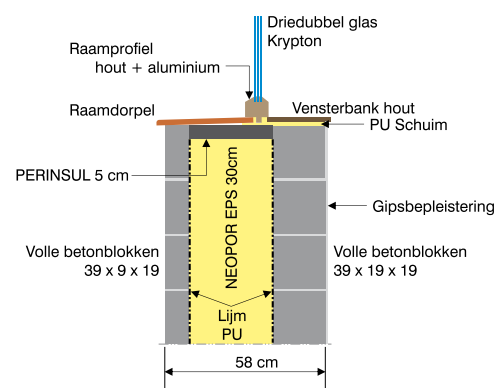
Constructiedetails van buitenmuur met raamaansluiting
